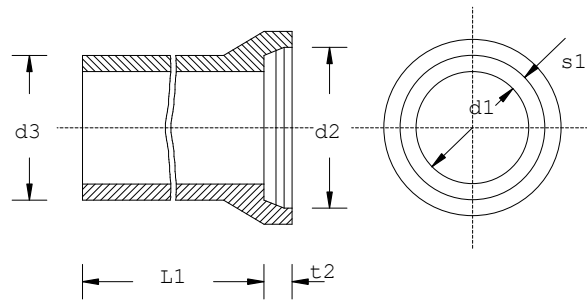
Tubi in calcestruzzo di sezione circolare con manicotto senza piede
